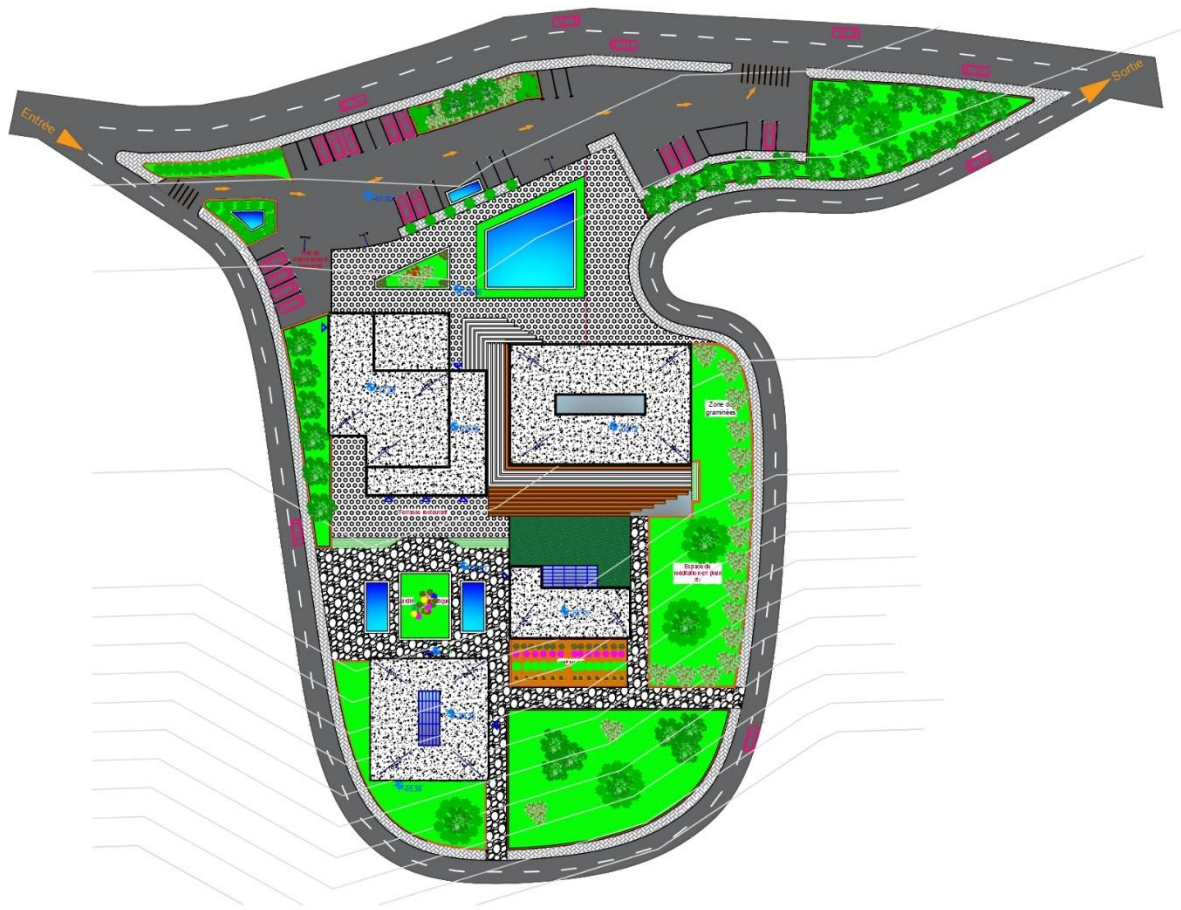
Plan masse de projet d'intervention. Source : Auteurs.
